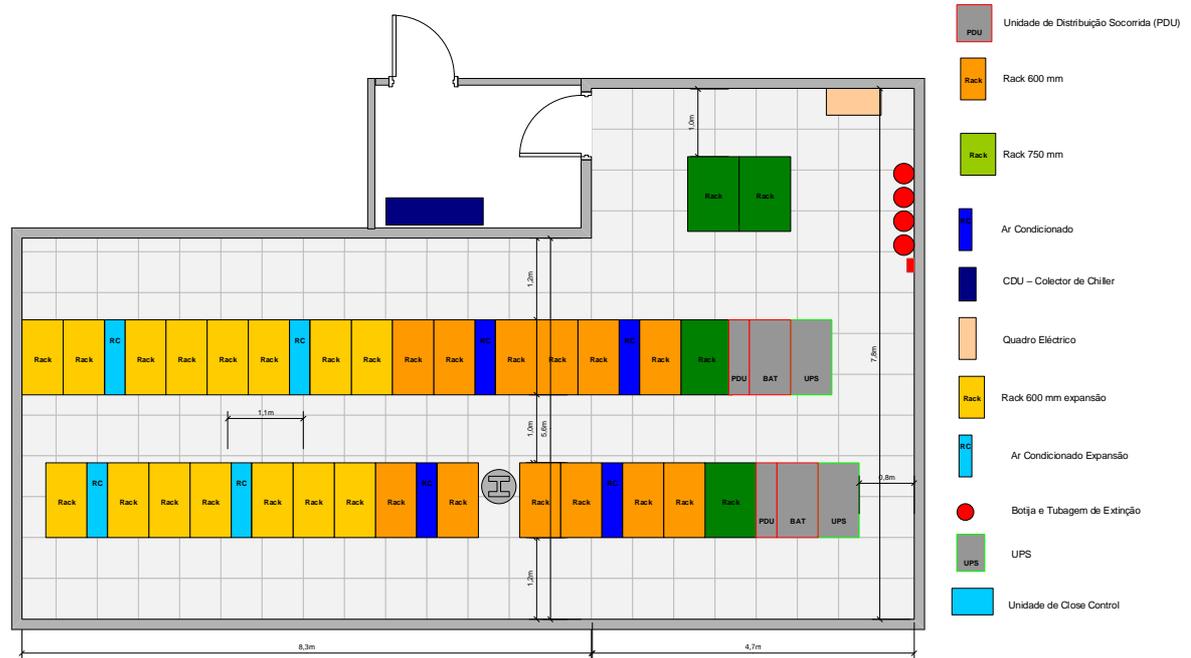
Planta de implantação e crescimento do centro de dados (Universidade de Aveiro)
